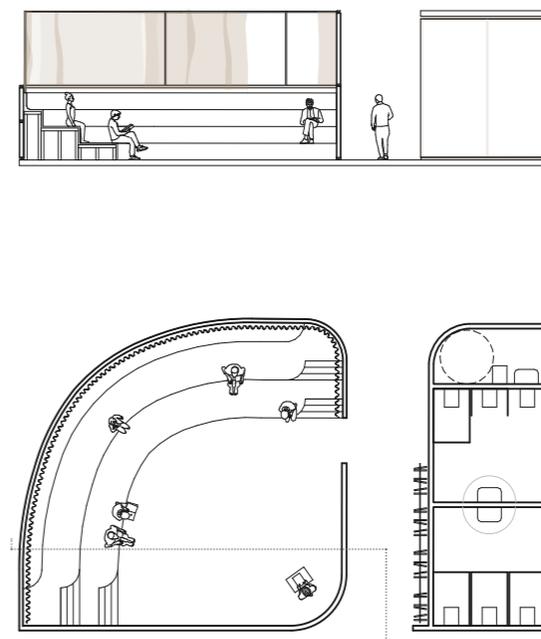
Vortragen: Schnitt und Grundriss
